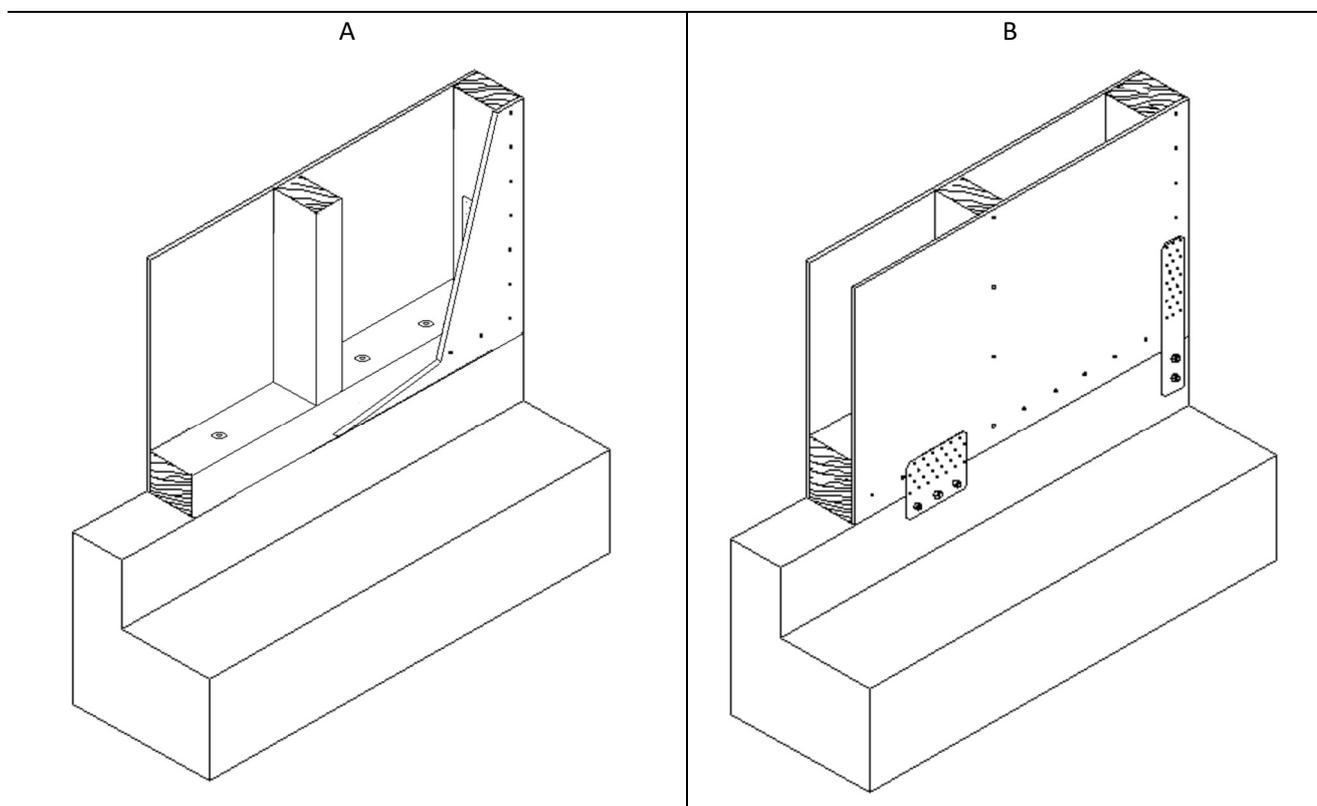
Soluzioni per il collegamento alle fondazioni. A collegamento con parete assemblata a piè d'opera o aperta. B collegamento con parete chiusa preassemblata in stabilimento
